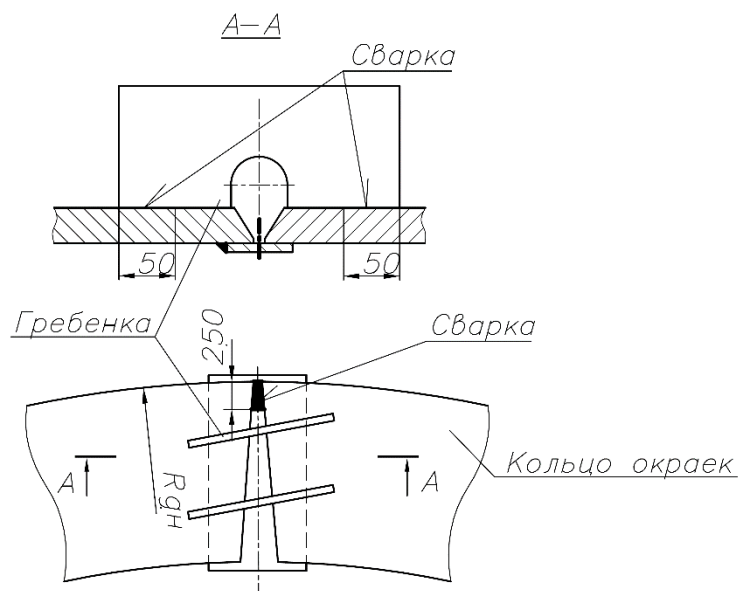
Сварка и зачистка стыка между крайками днища
